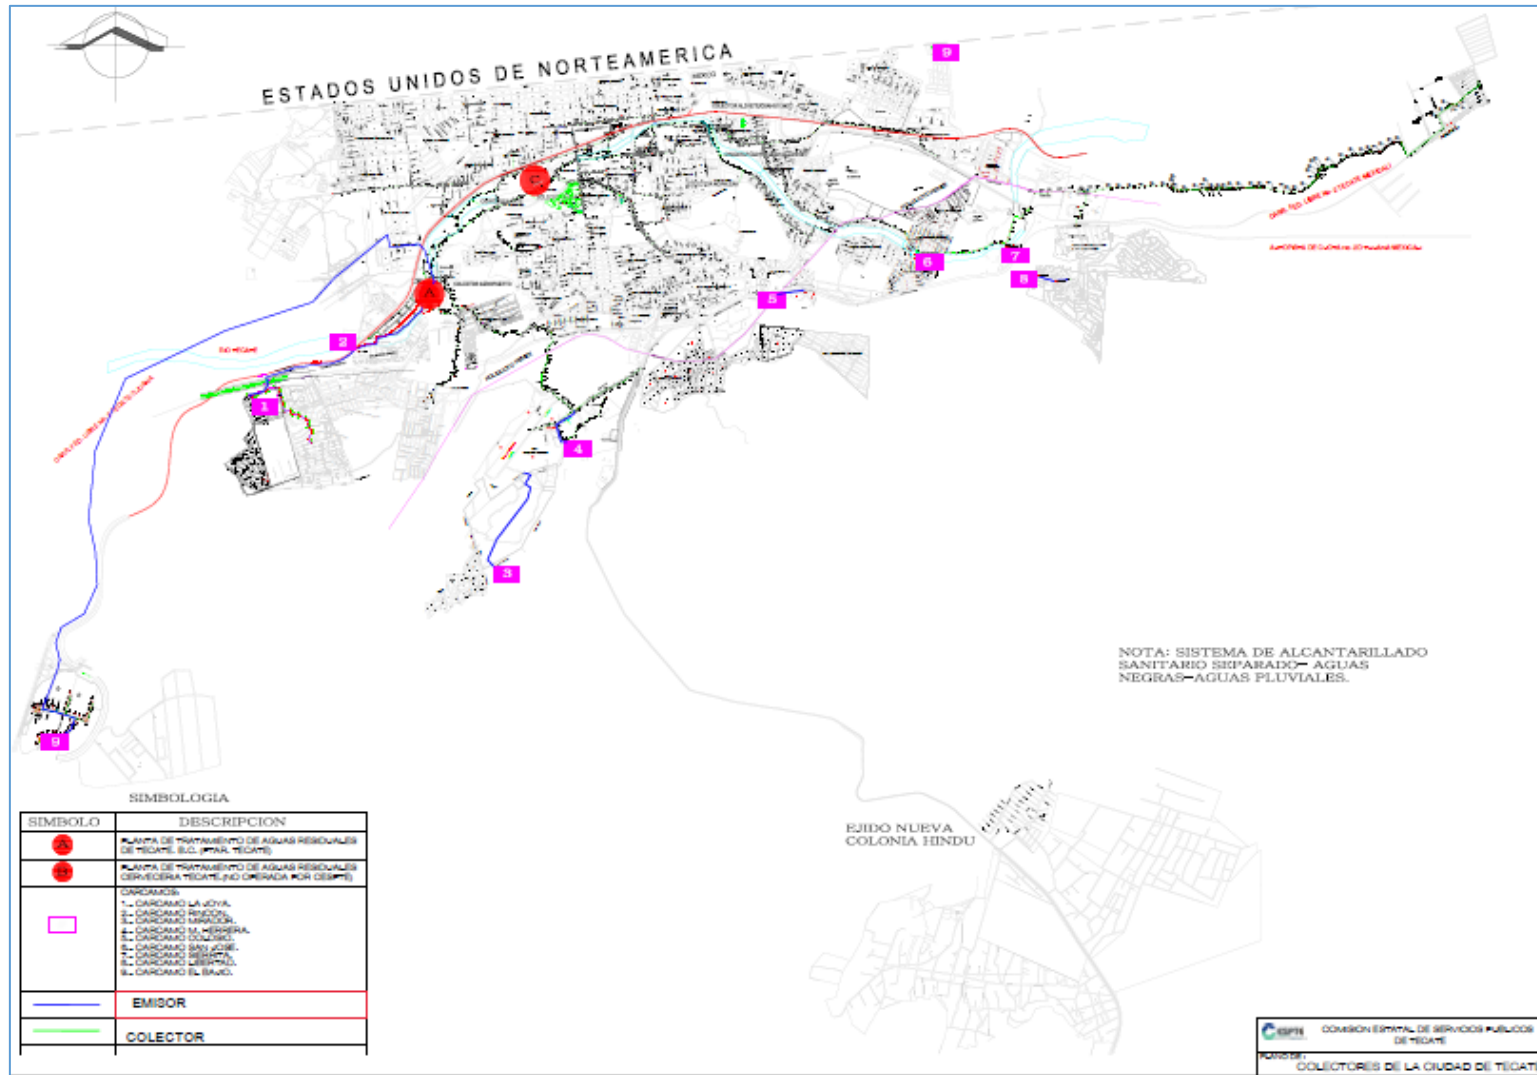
Plano del sistema de alcantarillado y saneamiento de Tecate.
